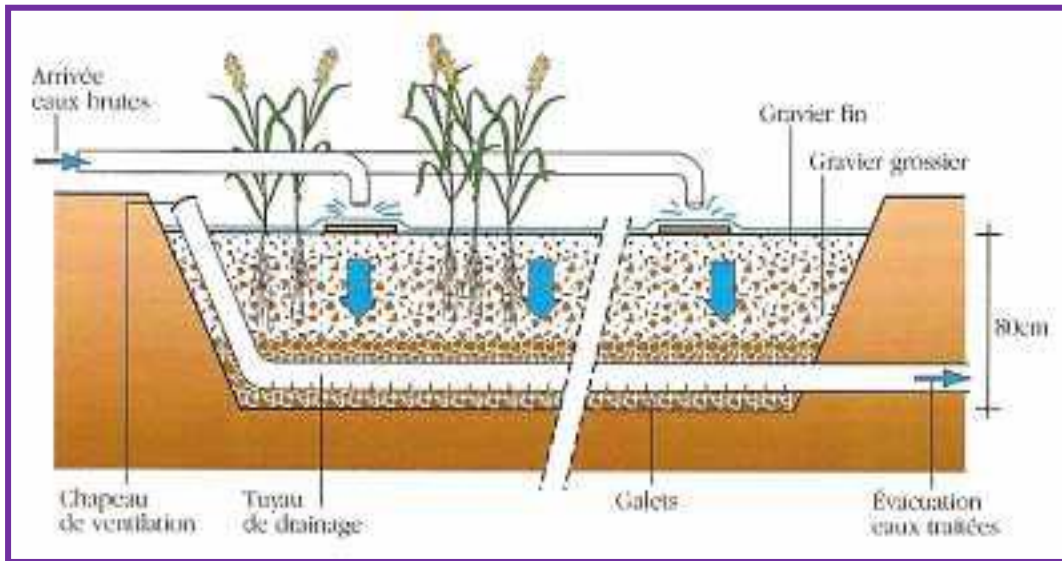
Coupe transversale schématique d'un filtre planté de roseaux.
